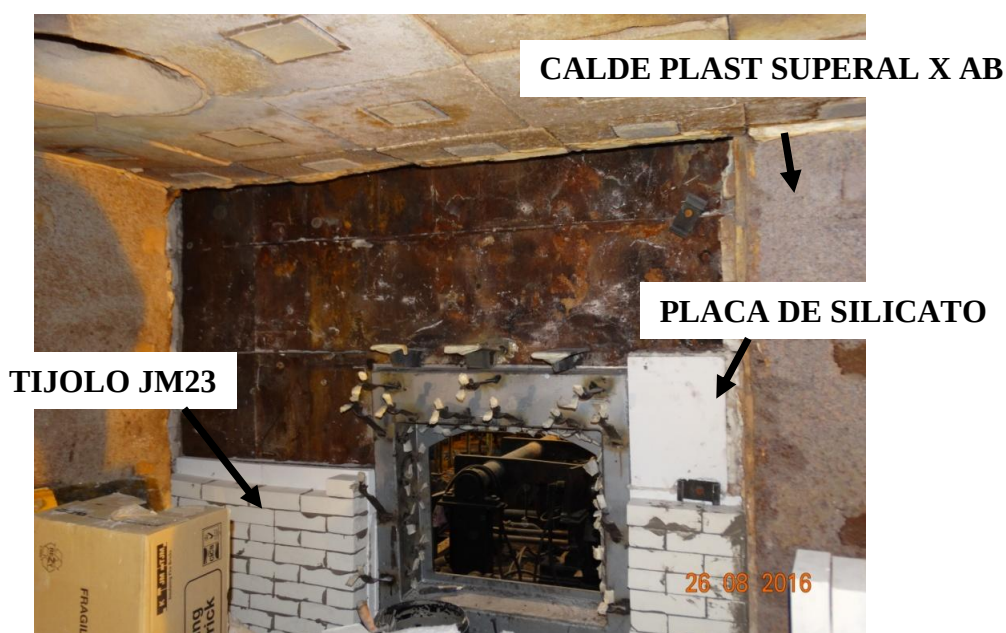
Pormenor da construção do sistema de isolamento das paredes
